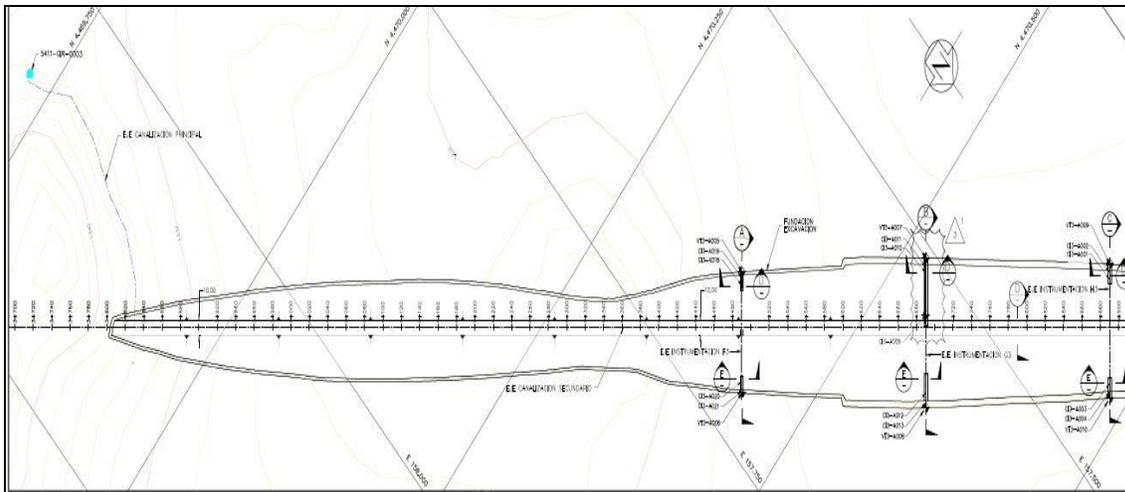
Planta General Muro N°2 MQCL-ST54-IND-5411-PLN-CVES-0056
